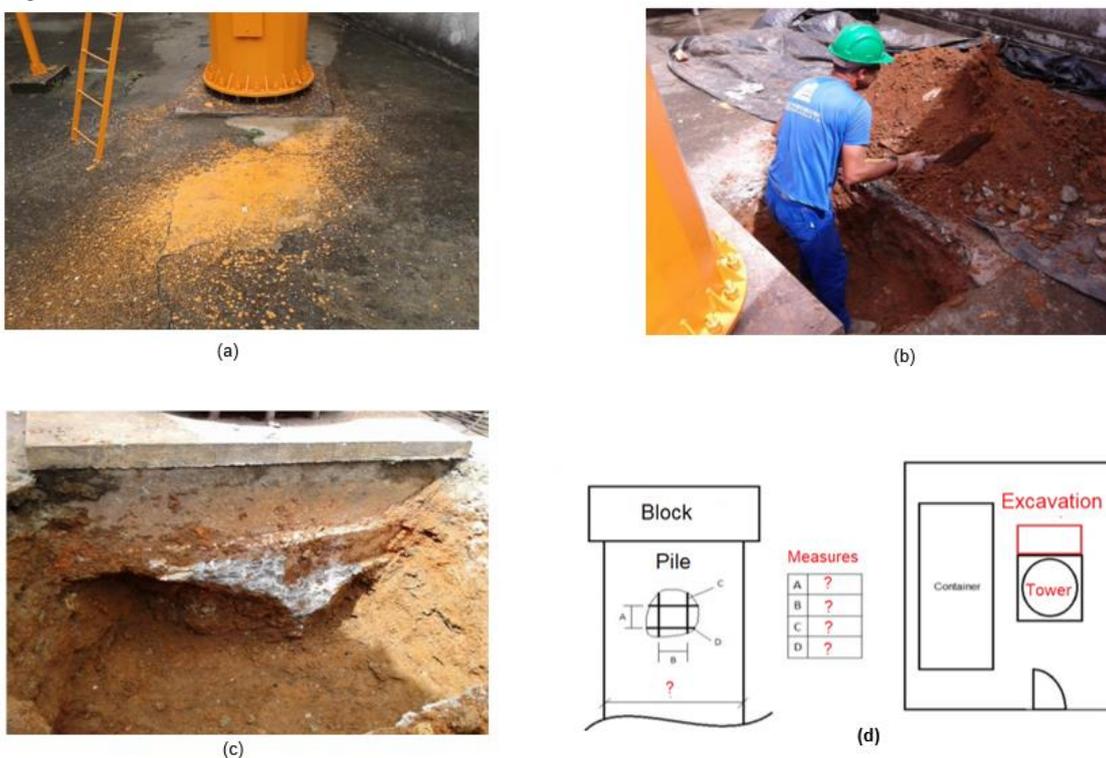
Vista geral do site. (a) Condição inicial antes da escavação, (b), etapas de escavação para acesso do operador do PIT, (c) Fundação parcialmente exposta para colocação do sensor (d), croqui esquemático da fundação mapeada.
